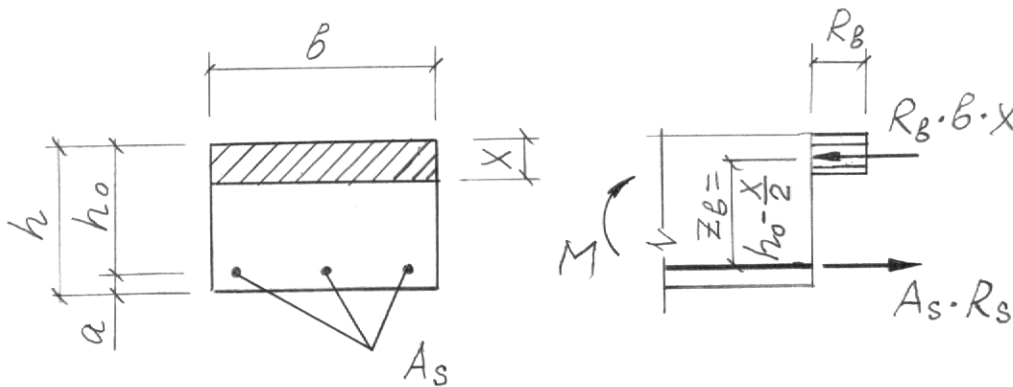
Розрахункова схема зусиль у прямокутному перерізі з одинарною арматурою
